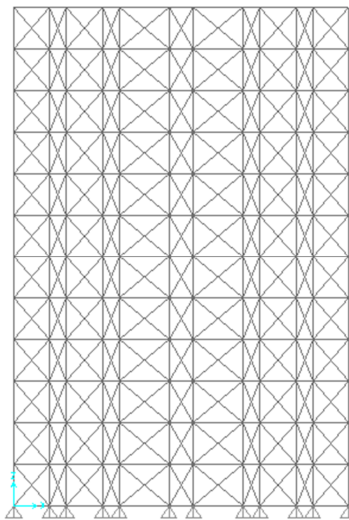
Configuração dos Planos de Contraventamento Vertical Com Elementos de Contraventamento Pequenos
